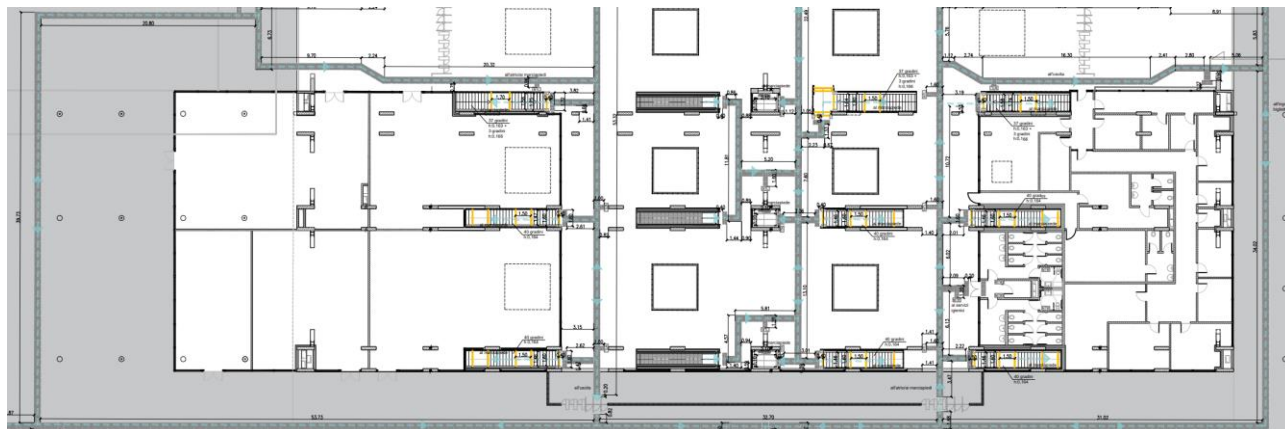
Stralcio Planimetria percorsi tattili Piano Ingressi ampliamento di stazione.
